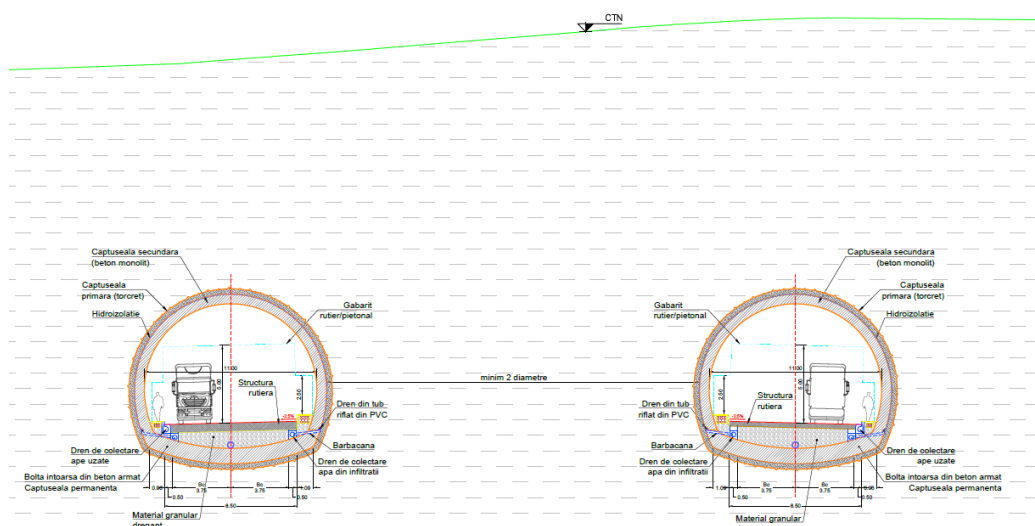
Secțiune transversală Tunel 1, km 72+960 – 73+480 (PTT04)
